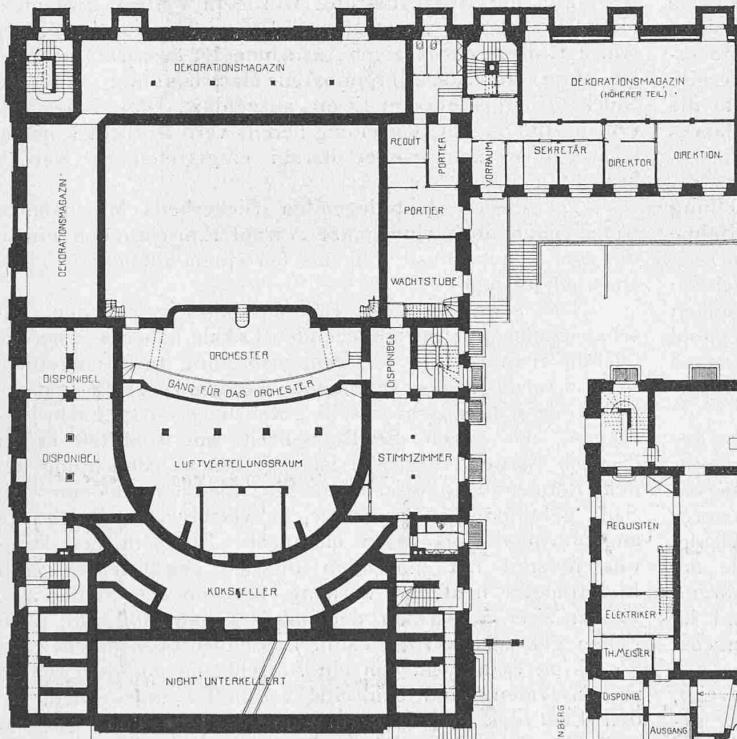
Grundriss vom Untergeschoss, — 1:500.
